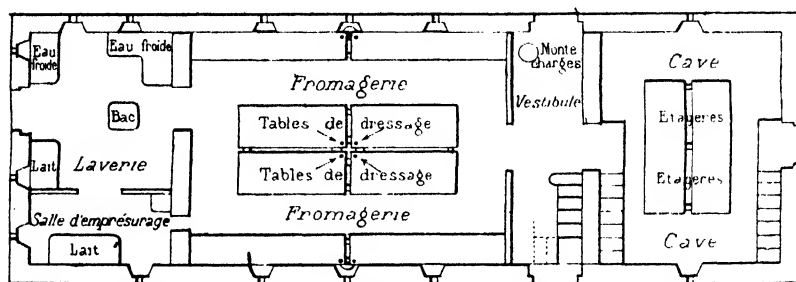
PLAN DU REZ-DE-CHAUSSEE
